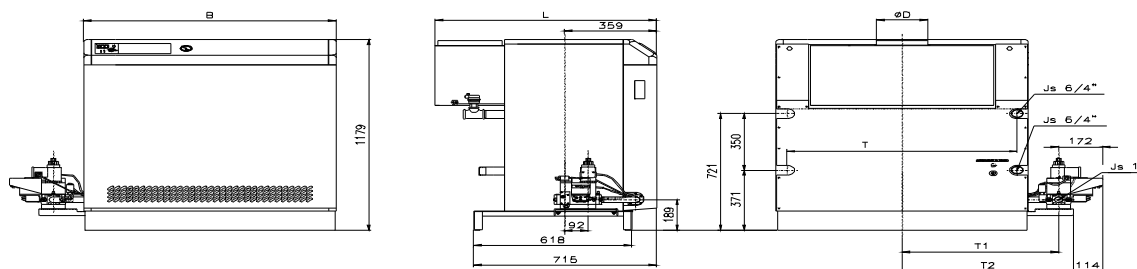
Размеры для присоединения котла W 80 (100, 120) HE
